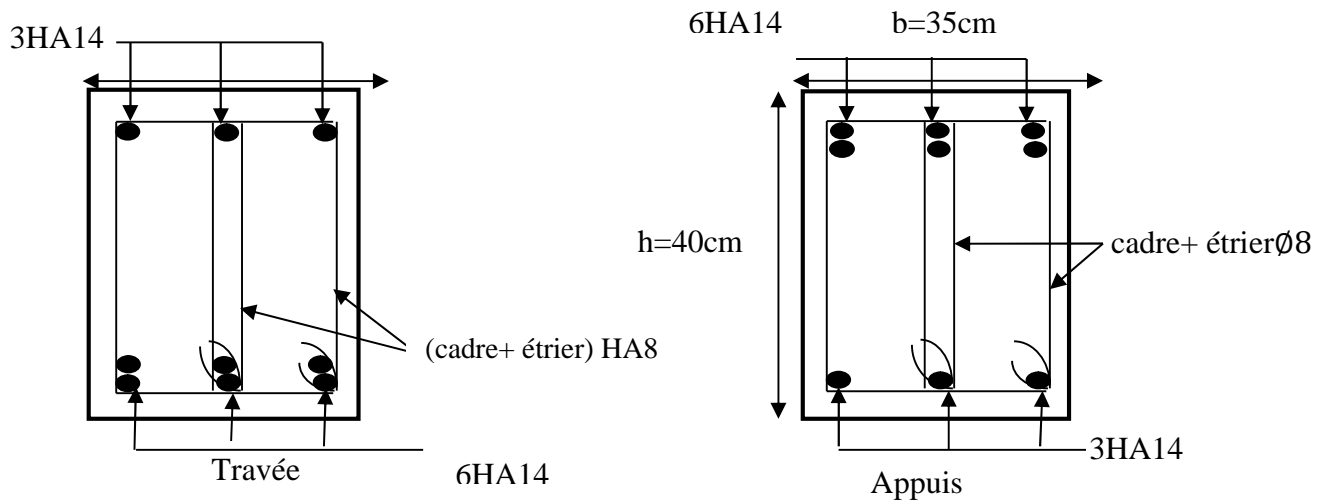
schémas de ferrailage des poutres principales (sous sol ; RDC)
